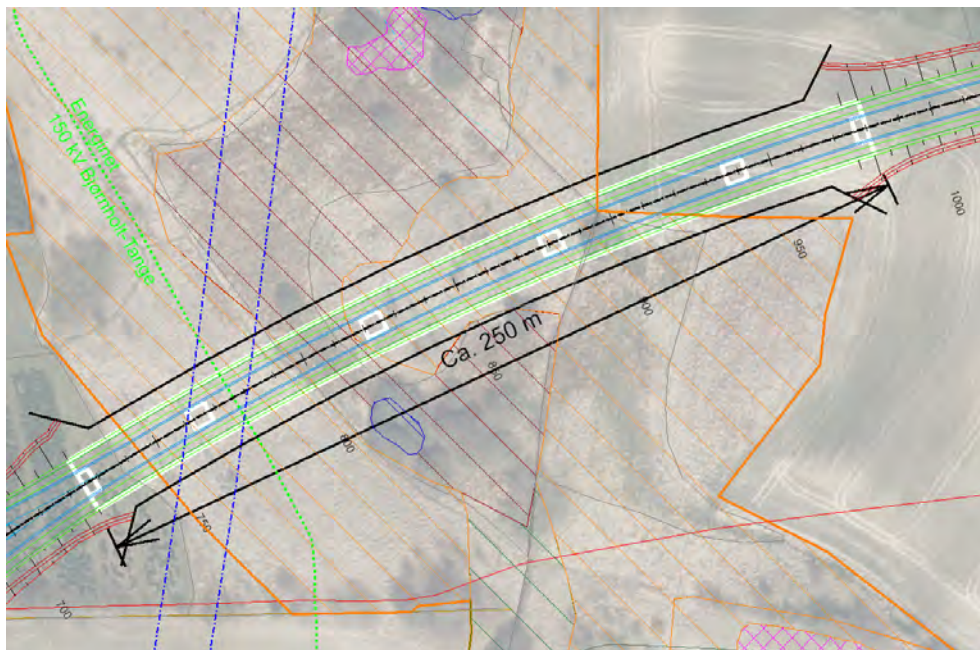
Oversigtsplan med ortofoto, projektforslag 1, omrids af planlagt bro er markeret med hvid.
